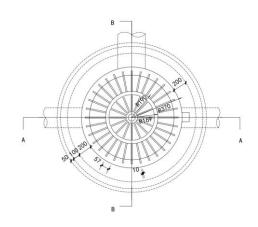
圆形溢流口平面图 (单位: mm)
